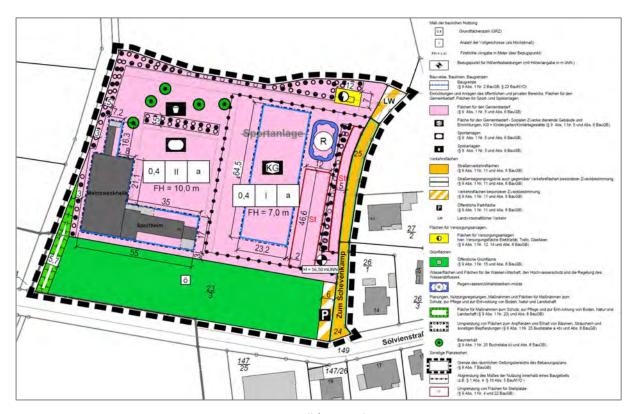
Bebauungsplan Nr. K 9 "Zum Schevenkamp" (Entwurf: plan HC Stadt- und Regionalplanung, Stand: 28.04.2021)
